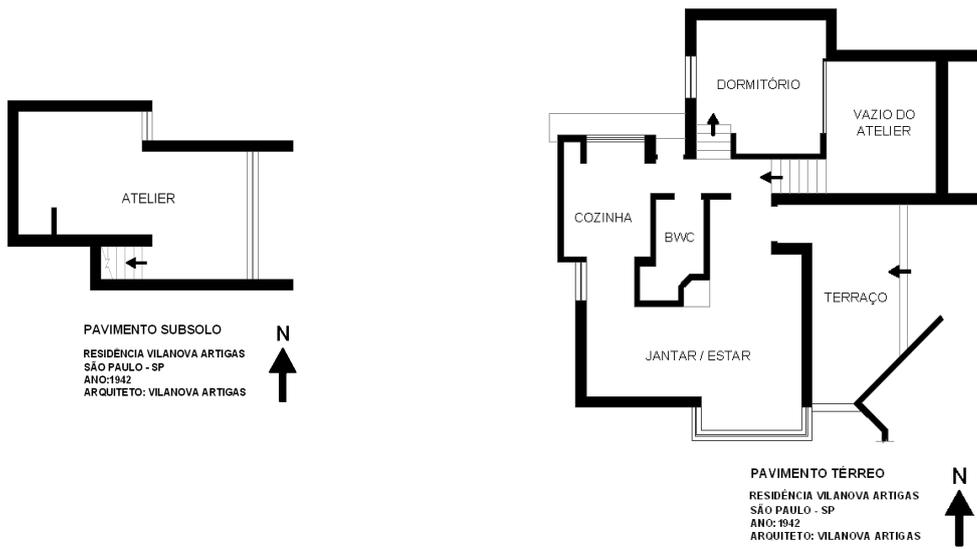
Redesenho das plantas baixas do subsolo e do térreo da residência de Vilanova Artigas.
